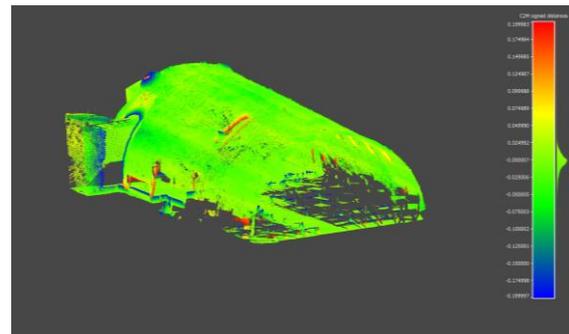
Abstand Modell zu Punktwolke
